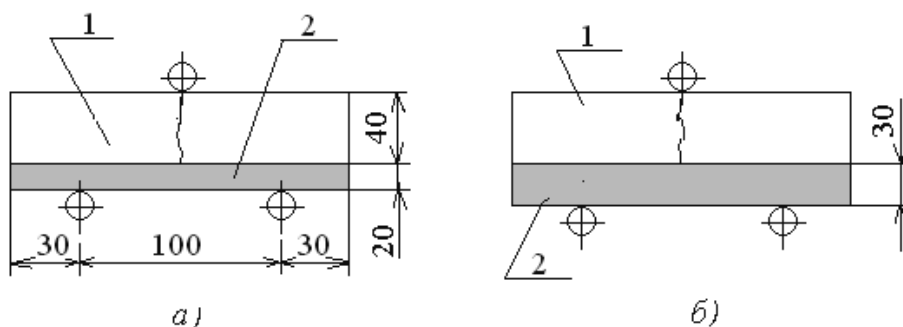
Схема испытания на растяжение при изгибе: 1 – нарушенный образец; 2 – восстанавливающий слой; а) – толщина покрытия фибробетона 20 мм; б) – толщина покрытия фибробетона 30 мм
